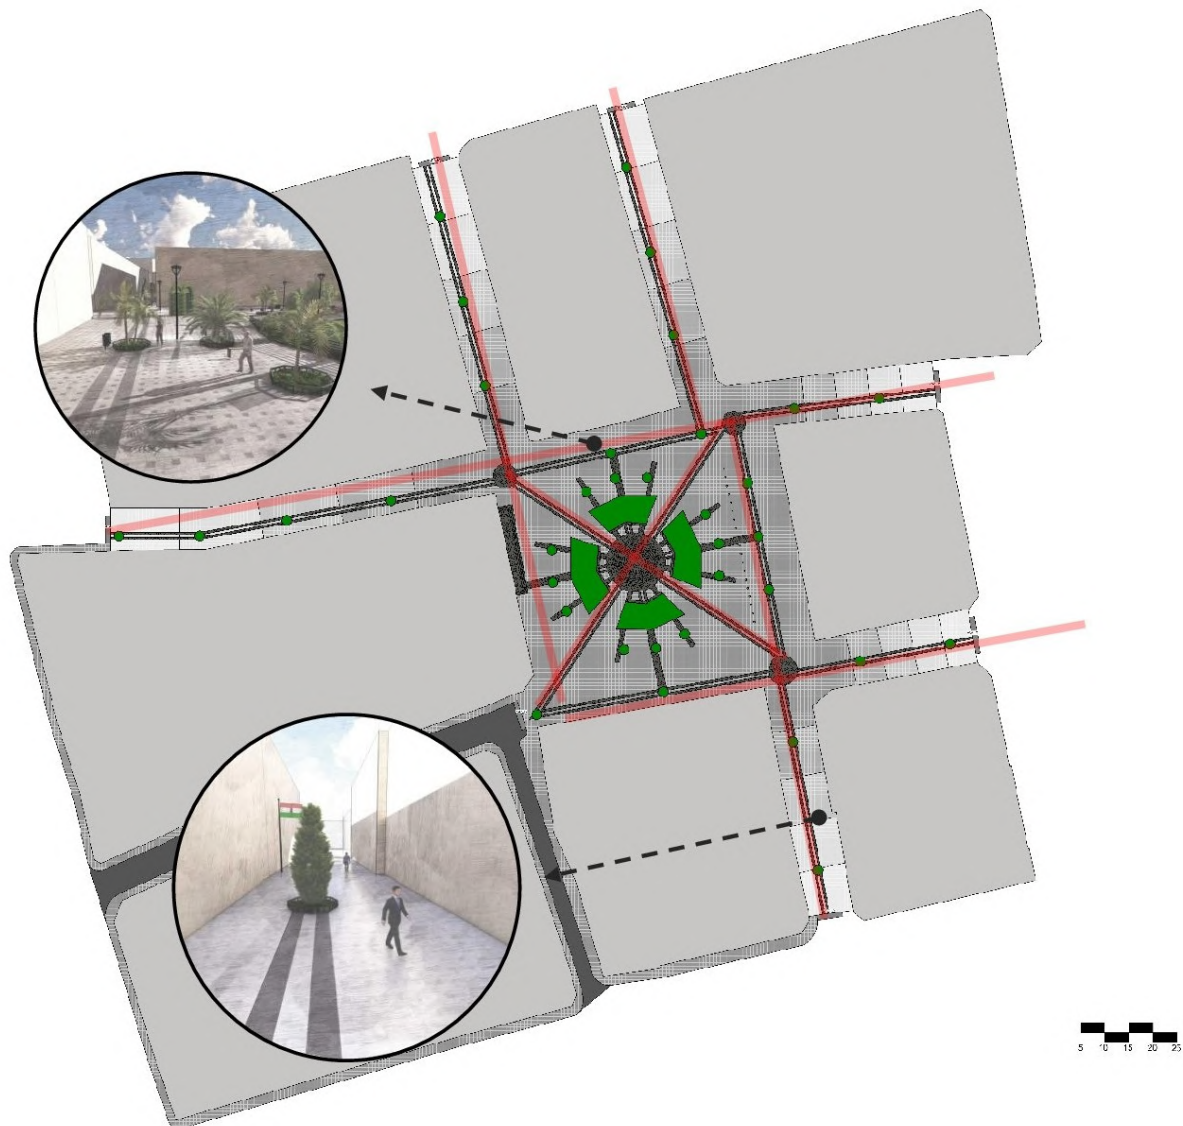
Planta de las camineras internas y externas del Parque central.
